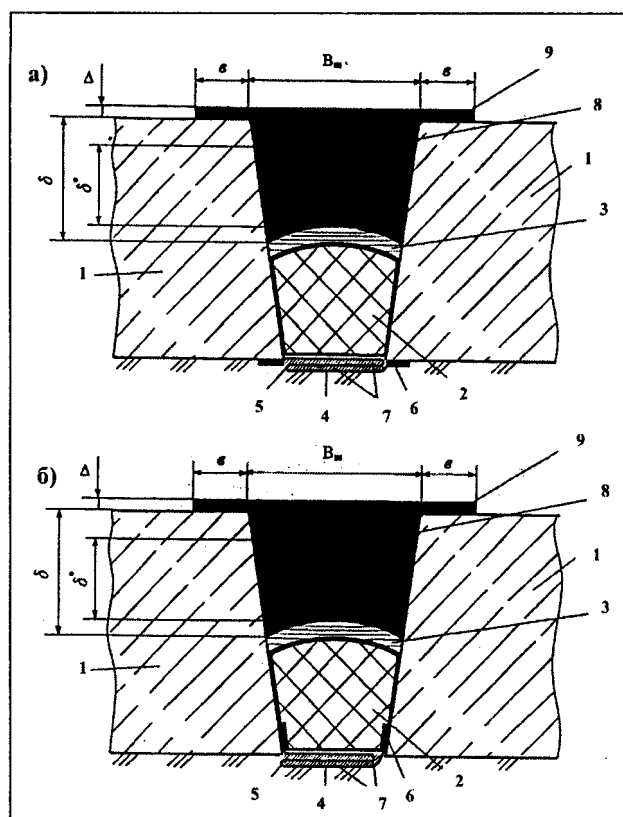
Деформационный шов противофильтрационной облицовки каналов и водоемов из битумно-полимерной мастики: 1 — бетонные или железобетонные плиты; 2 — пороловая прокладка; 3 — противоадгезионный слой; 4 — гидроизоляционная прокладка; 5 — компенсатор; 6 — участки приклеенной гидроизоляционной прокладки к стыкуемым плитам облицовки; 7 — пластичная, гидрофобная и морозостойкая смазка; 8 — битумно-полимерная мастика; 9 — заплечики из битумно-полимерной мастики.
